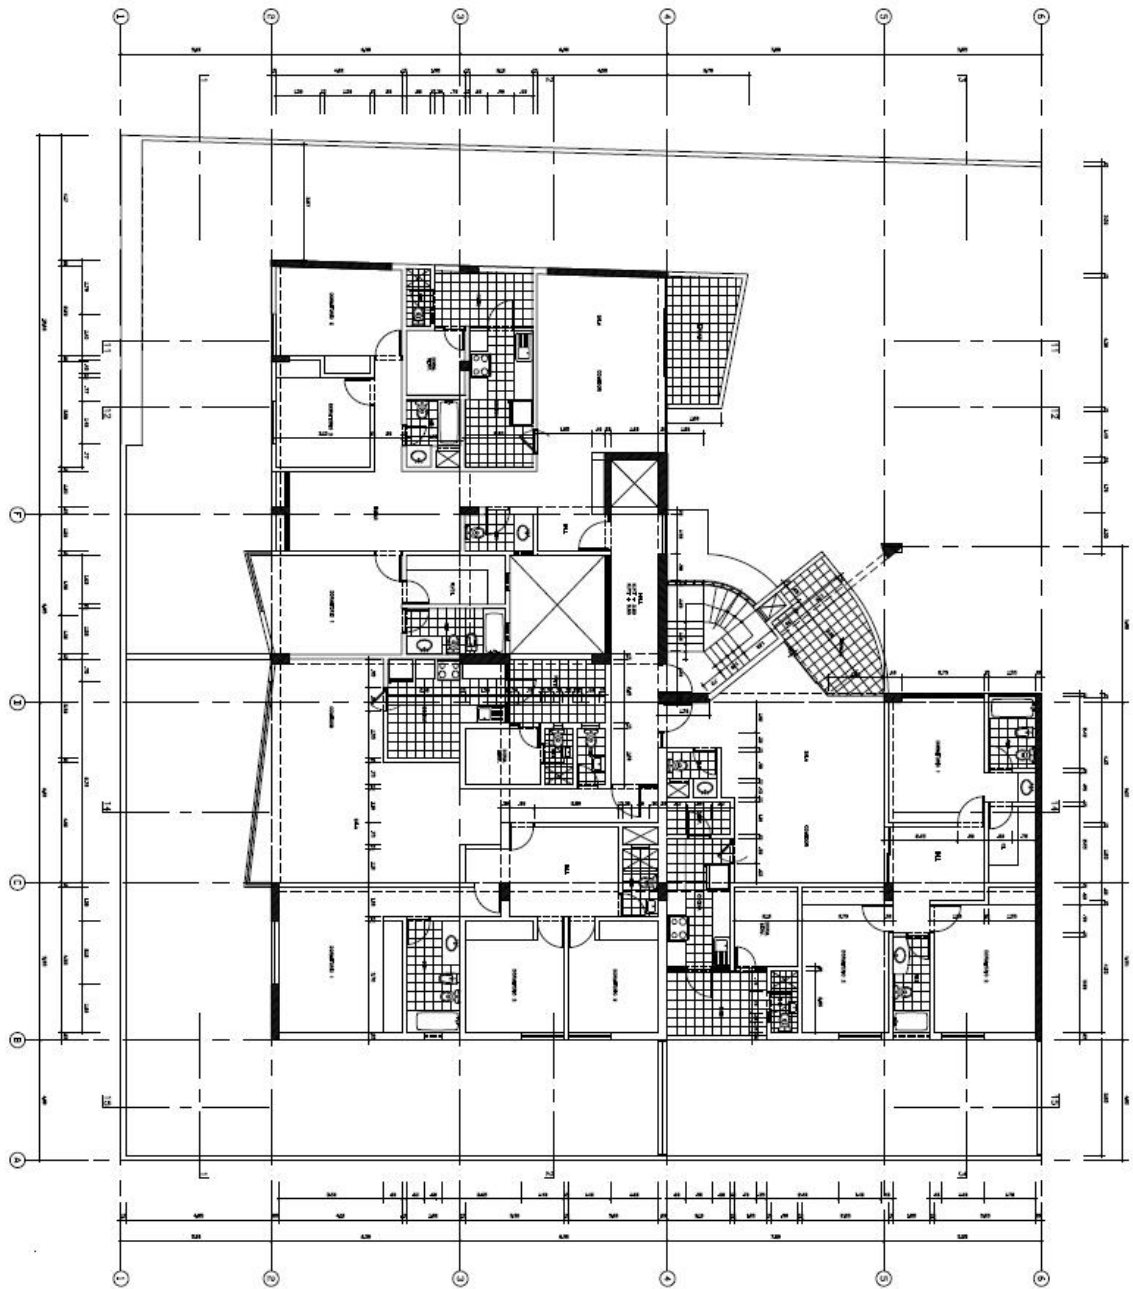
Planta Típica del Edificio de 5 pisos con sótano Bloque A
